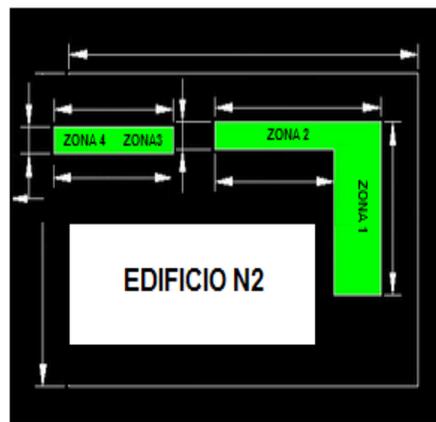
Plano del proyecto por zonas 1, 2,3 y 4.
